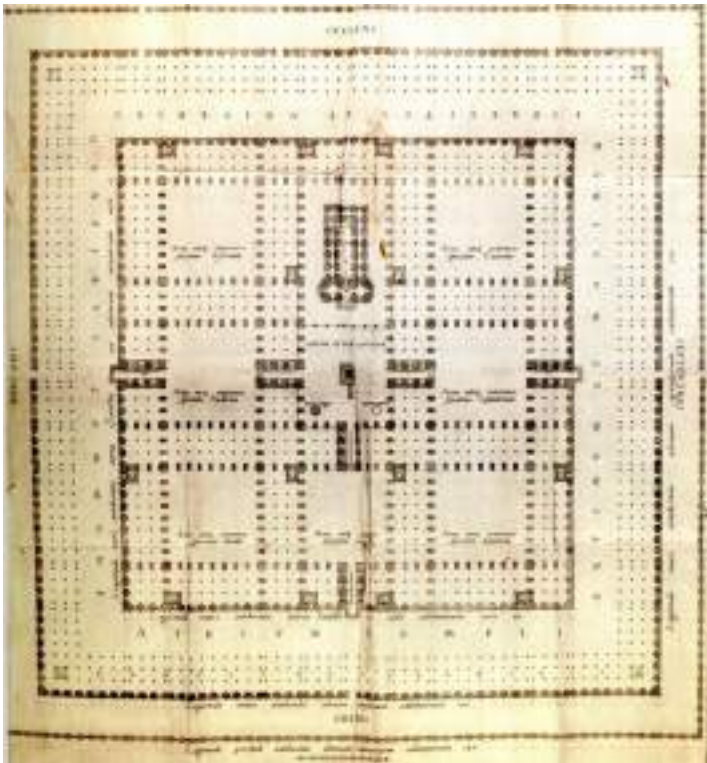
J. B. Villalpando, *Ricostruzione della pianta del Tempio di Salomone a Gerusalemme*, (dalle "Ezechielem Explanationes", 1604)
